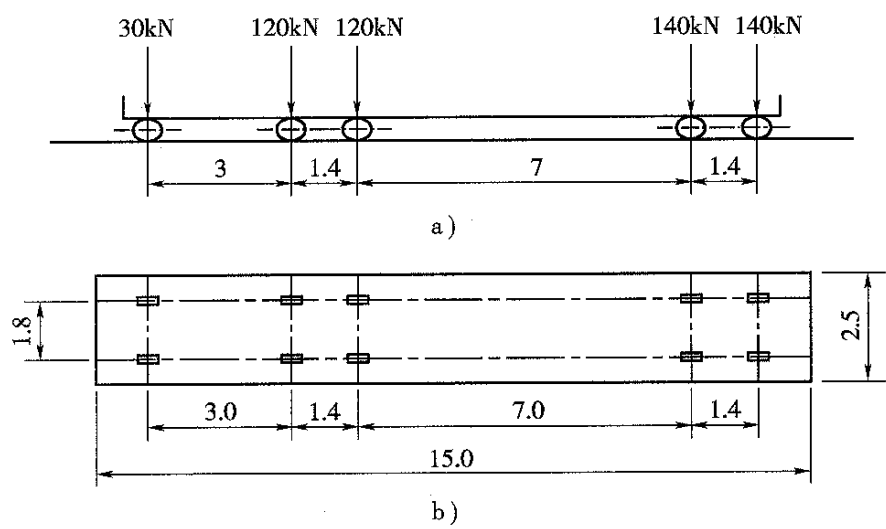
车辆荷载的纵、平面尺寸(尺寸单位:m)
